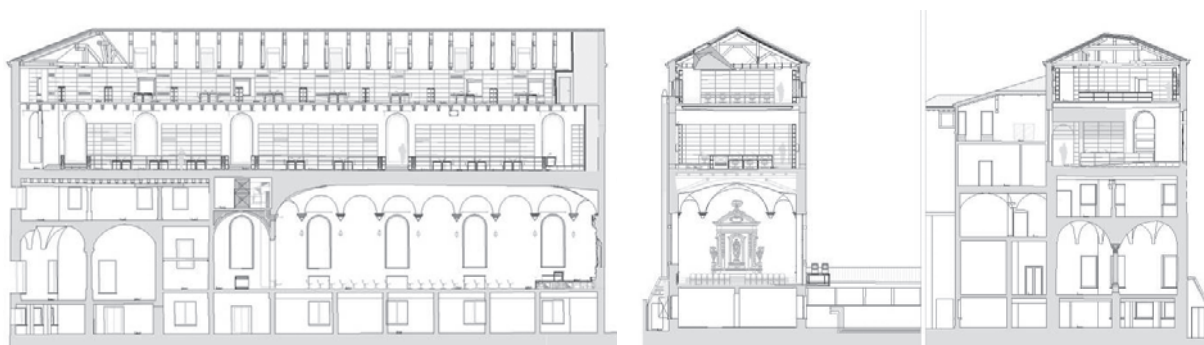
Viste del progetto di ristrutturazione dell'ala Sud. Sezione longitudinale a sinistra e sezioni trasversali a destra
